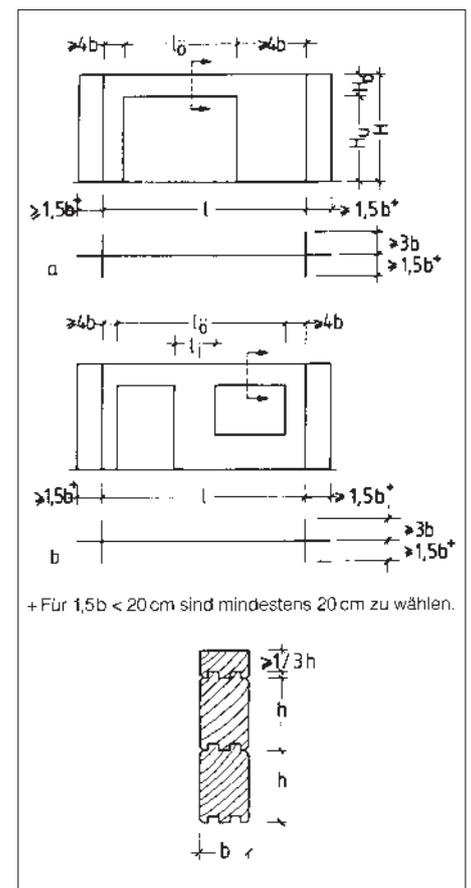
Abmessungen von Wänden mit Öffnungen; a eine Öffnung; b zwei Öffnungen
